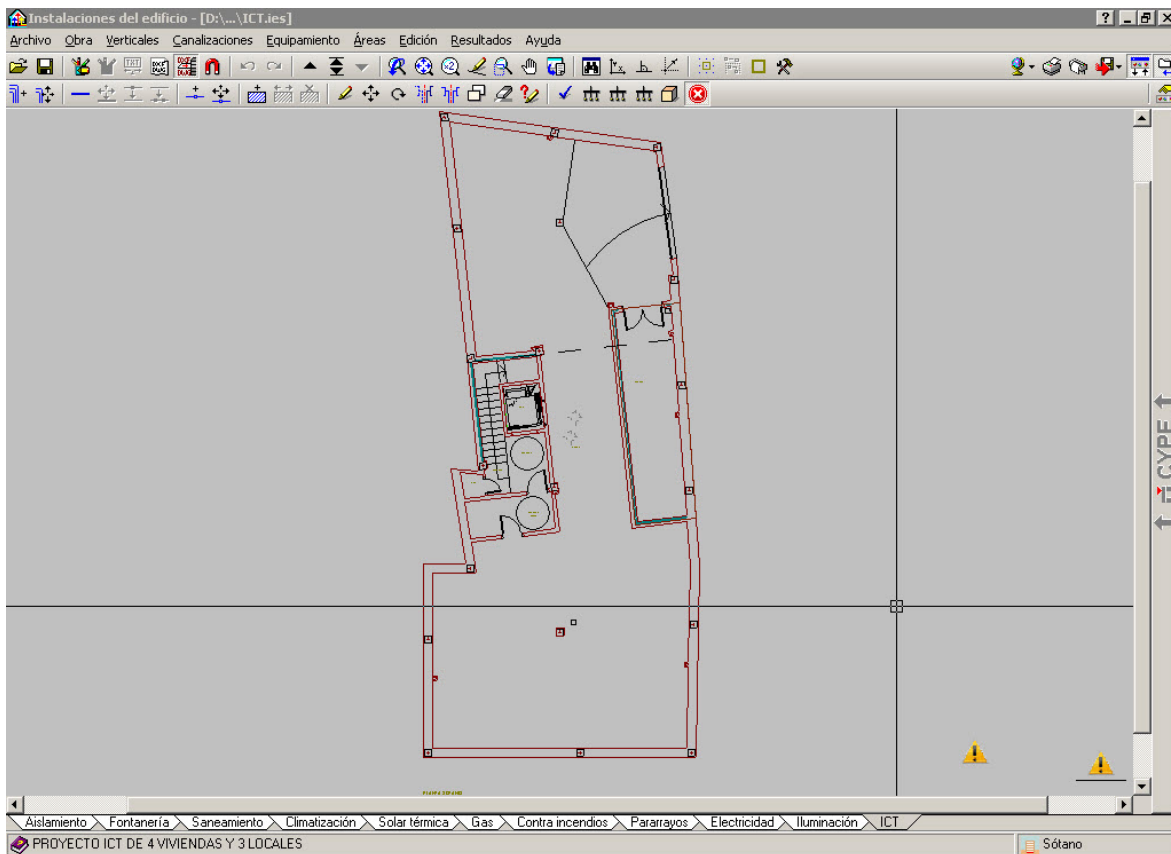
Instalación ICT planta semisótano (dimensionada)
